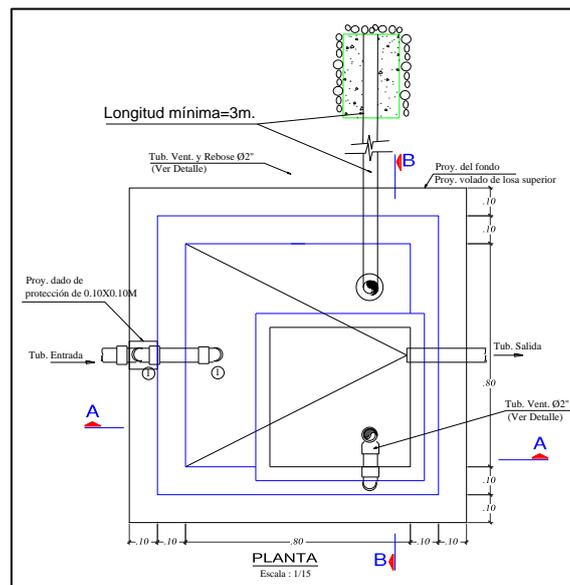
Vista en planta del detalle de Cámara Rompe Presión Tipo 6.
